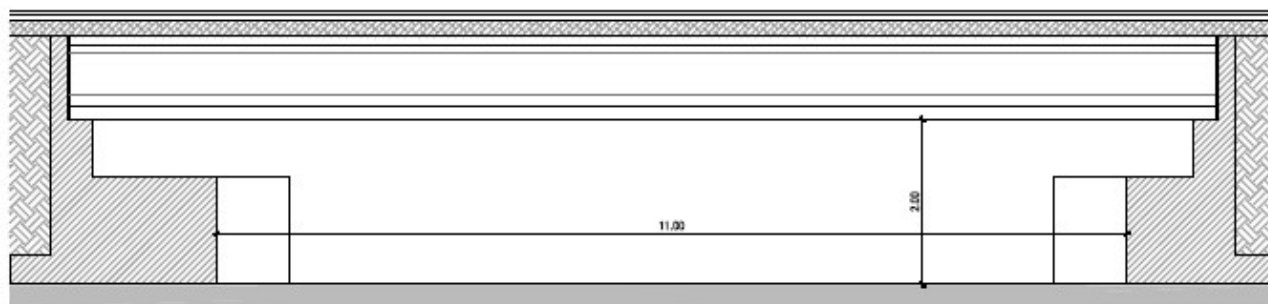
estratto tavola 2 stato di fatto - progetto 'Demolizione e ricostruzione ponte sul canale tombato Corso Vittorio Veneto': la sezione E-E interseca il manufatto del viadotto non oggetto di intervento
